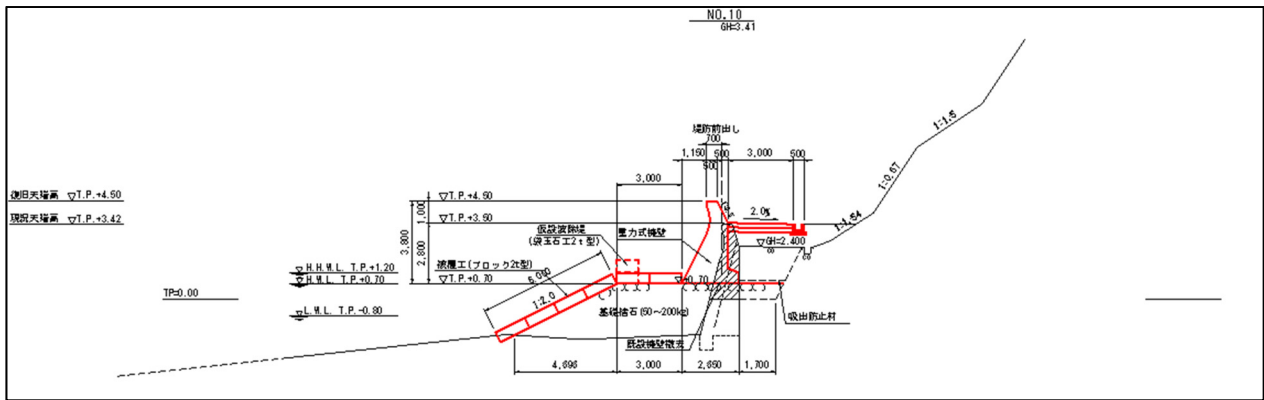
復旧計画平面図 (2工区:田尻地区)【高井浜大向海岸】
